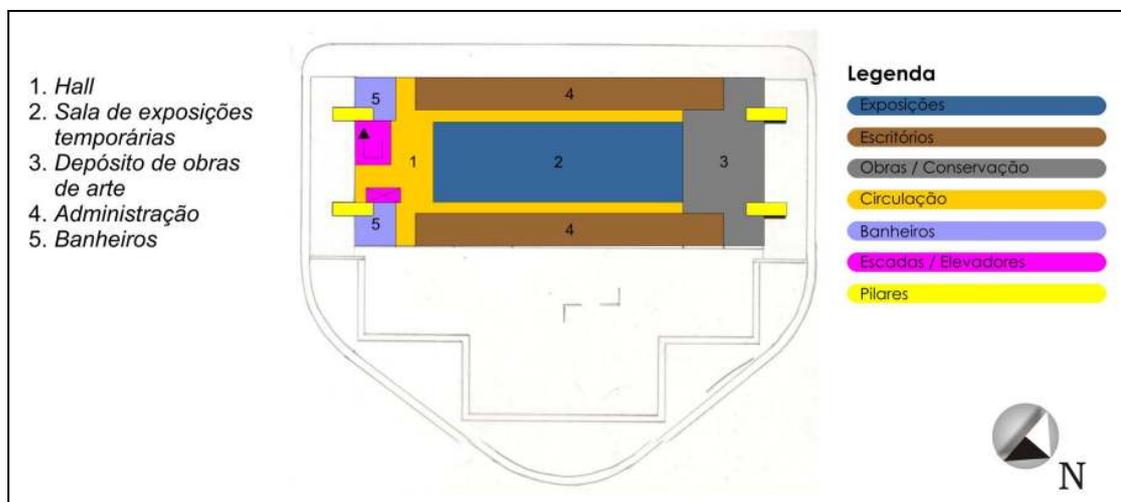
Planta baixa do 1º andar (adaptada de BARDI, 1992).
